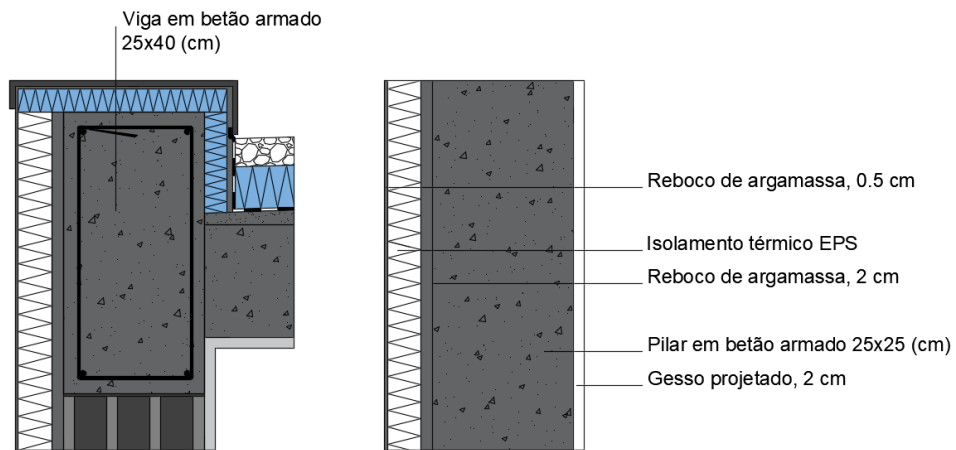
Pormenor construtivo base das pontes térmicas planas (viga e pilar).
